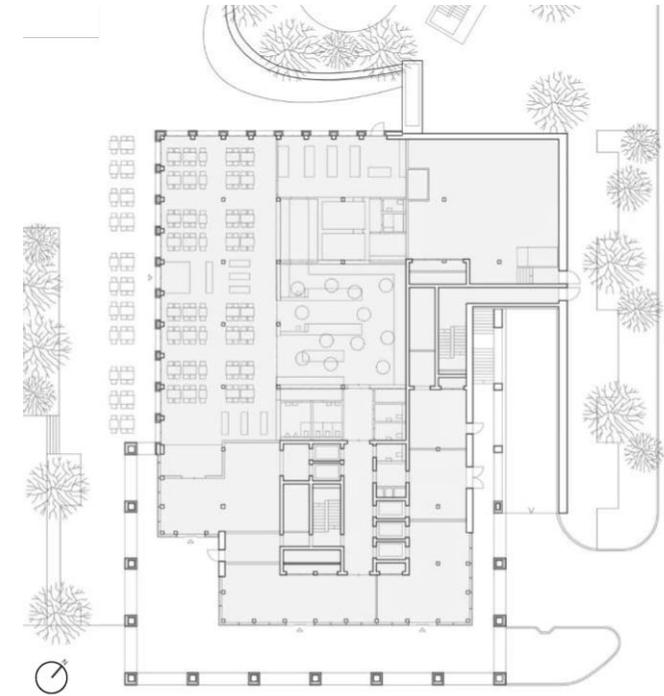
Grundriss, Erdgeschoss, STB-Konstruktion
